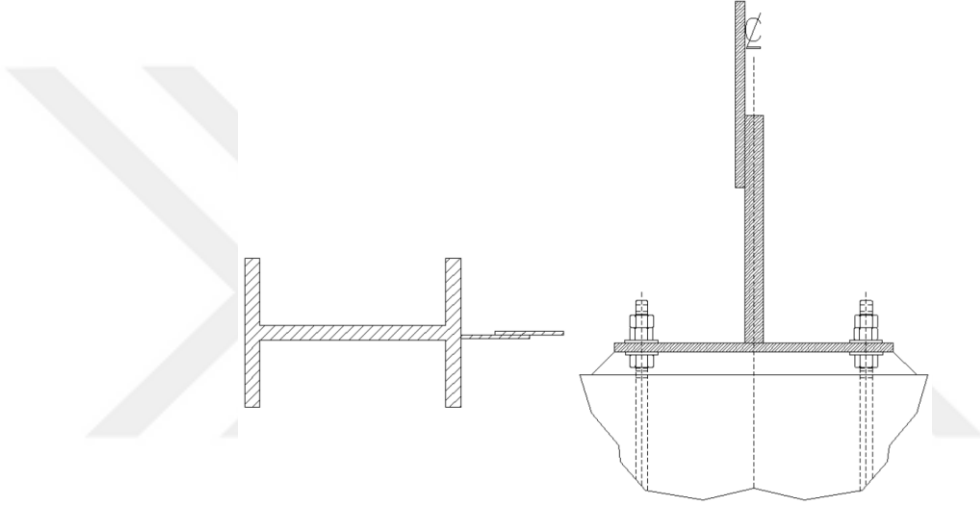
Çelik plakalı perde duvar sisteminde dayanım aşamaları. (Cyclic test of steel plate shear walls using box-shape vertical boundary elements with or without infill concrete, 2017)
